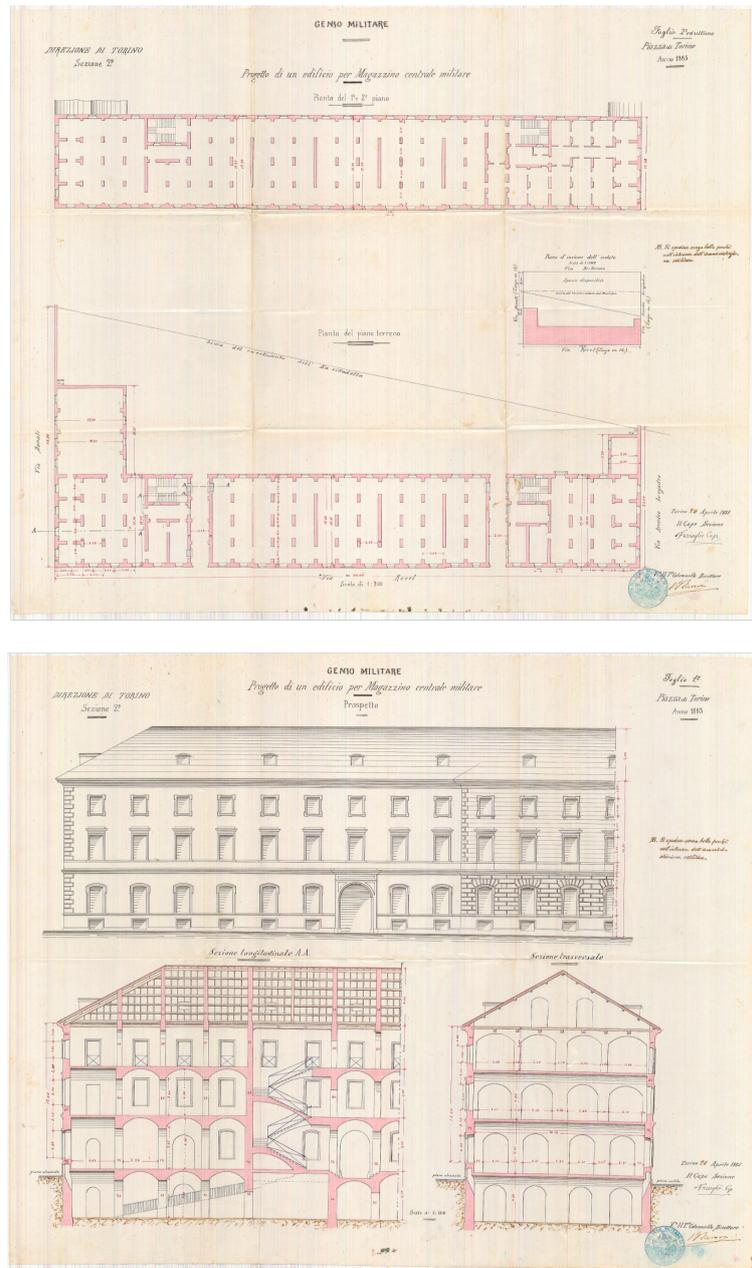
Progetto per il Magazzino centrale militare in via Revel. Pianta del primo e secondo piano (in alto), prospetto e sezione longitudinale e trasversale (in basso), del 10 Aprile 1885
